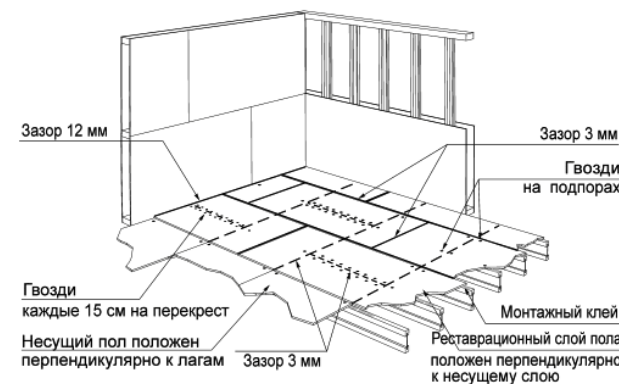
Схема укладки и крепления плит OSB к элементам перекрытия каркаса.
